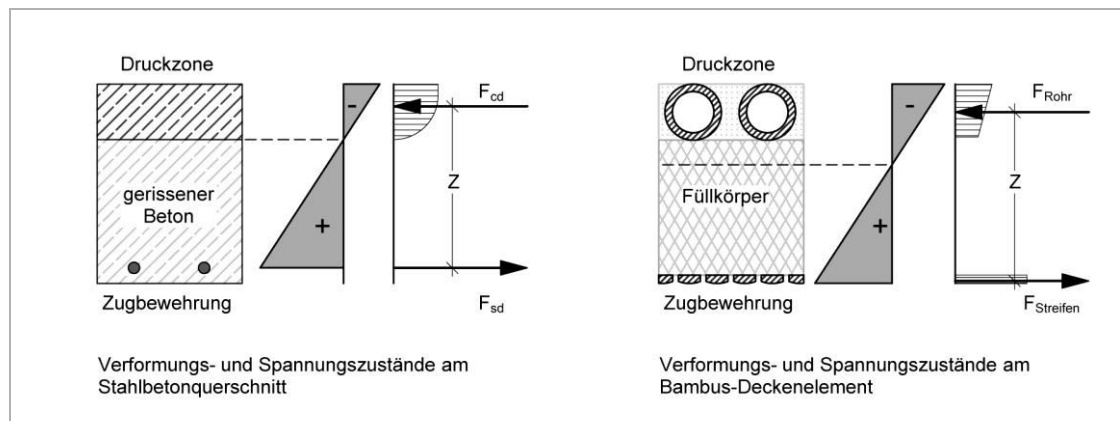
Materialausnutzung und Spannungen der Bambusdecke im Vergleich zu einer Stahlbetondecke.
